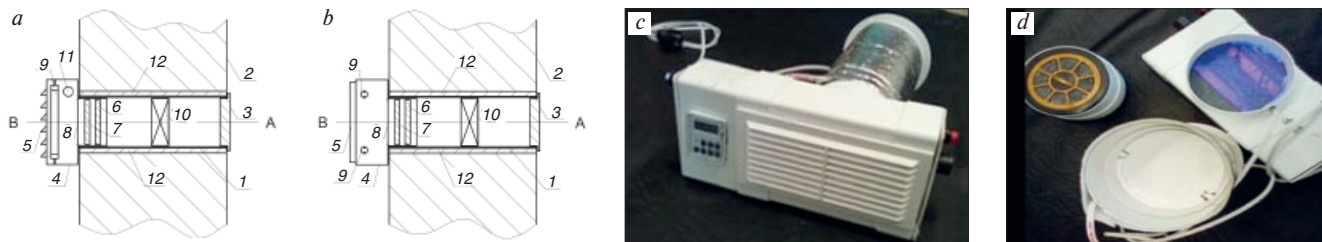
Стеновой приточный клапан принудительной вентиляции с очисткой поступающего воздуха: *a* – А–А – вертикальный разрез; *b* – вид сверху: 1 – круглая ПВХ труба (воздуховод); 2 – стена наружная; 3 – решетка; сетка до 1 мм; 4 – пластиковый прямоугольный оголовок; 5 – щели; 6 – фильтр сорбционный: шунгит (размер фракций 1 мм); 7 – фильтр сорбционный: цеолит (размер фракций от 1–3 мм); 8 – пластина диоксида титана (TiO_2); 9 – две ультрафиолетовые лампы, длина волны 365 нм, 6 Вт; 10 – электровентилятор; 11 – регулятор оборотов с выключателем + программатор; 12 – тепло- и шумоизоляция (изолон фольгированный); *c*, *d* – общий вид клапана
